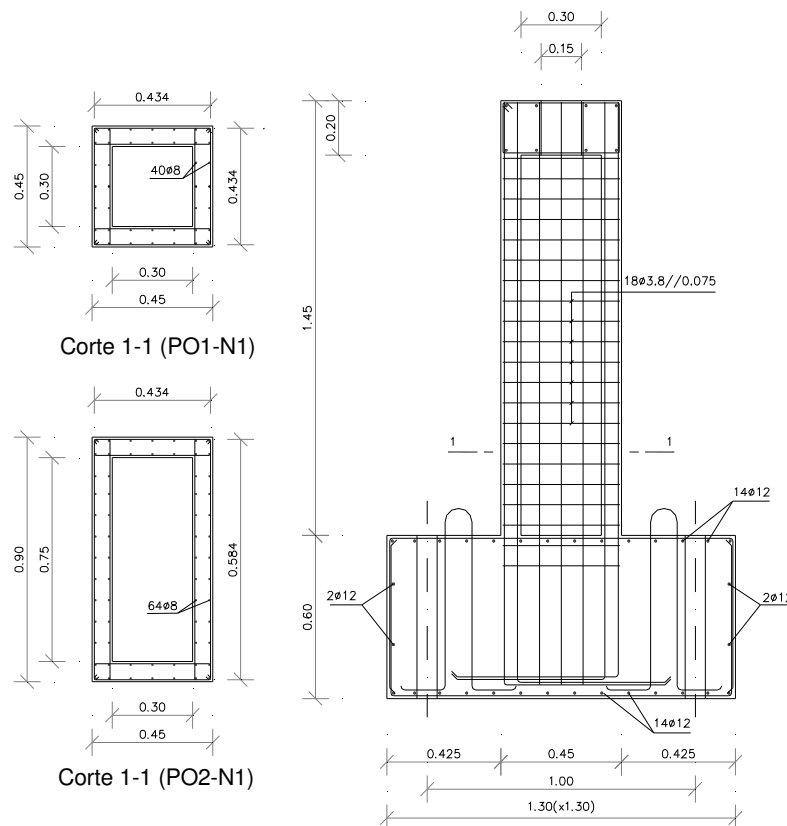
Pilares N1 em betão armado (Escala 1:4)
